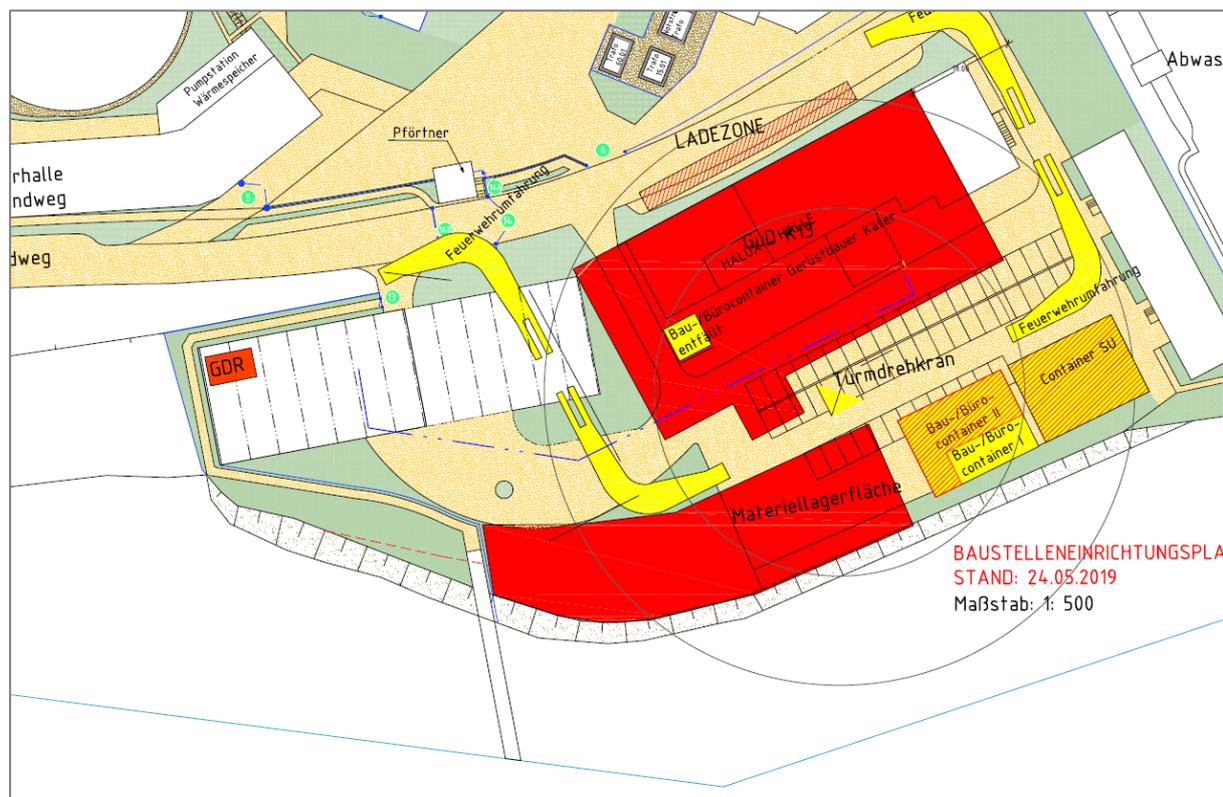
Lageplan Baufeld für den Neubau der GuD-Anlage K13
